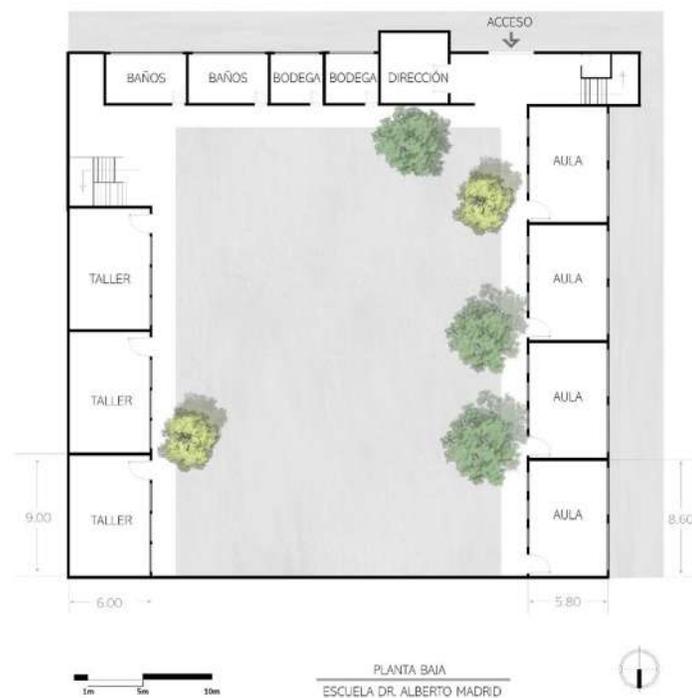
Planta escuela Dr. Alberto Madrid, 1963.
